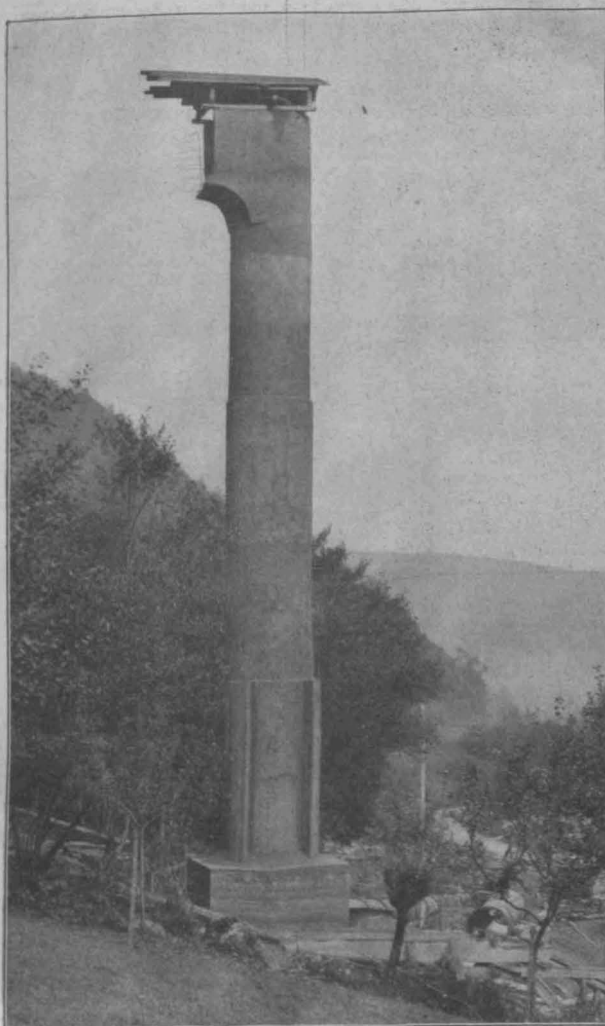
Eisenbeton-Steigschacht vor der Umhüllung.
